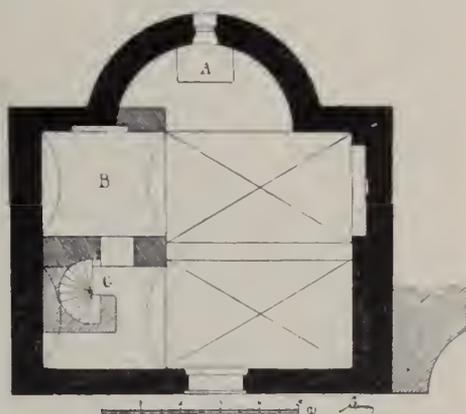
Xanten. Grundriss der Dionysiuskapelle
